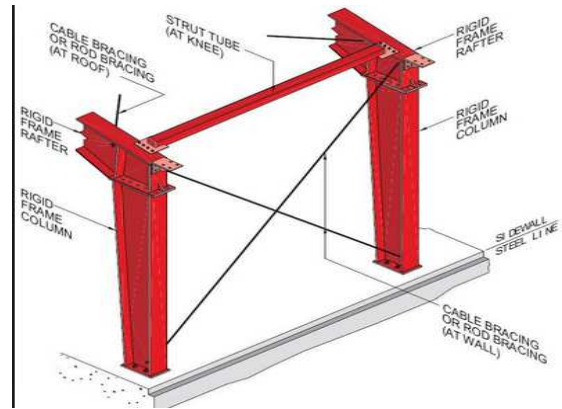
assemblage poteaux poutre source: <http://www.batirama.com>
